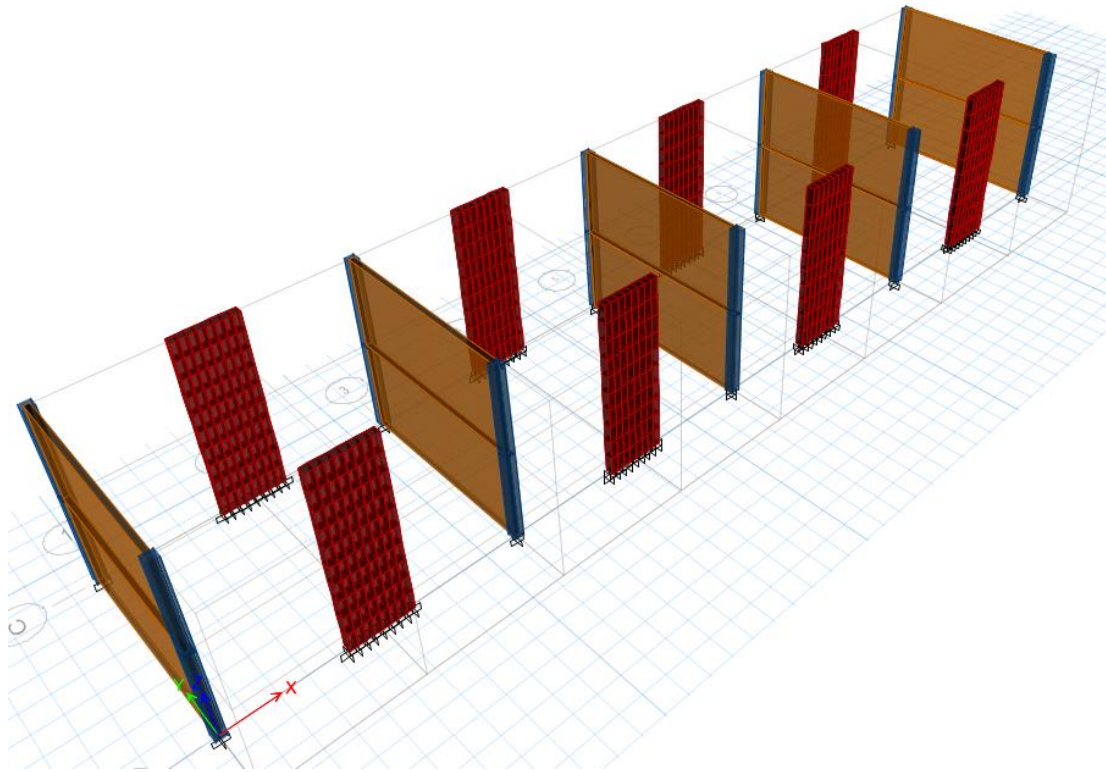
Vista en planta de los muros de corte en la dirección “X” del módulo 4.
